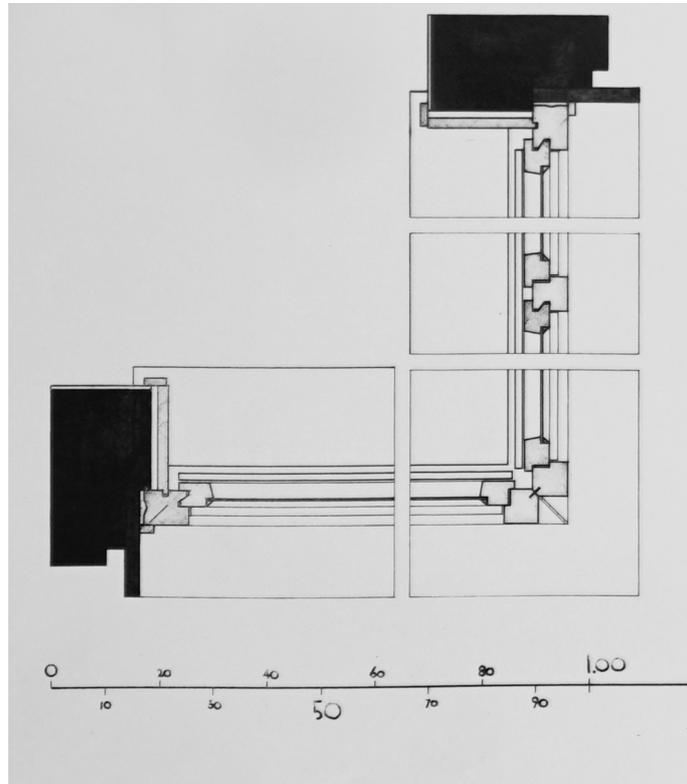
Wohnblock Habichtstraße, Detail Eckfenster, o. Datum
